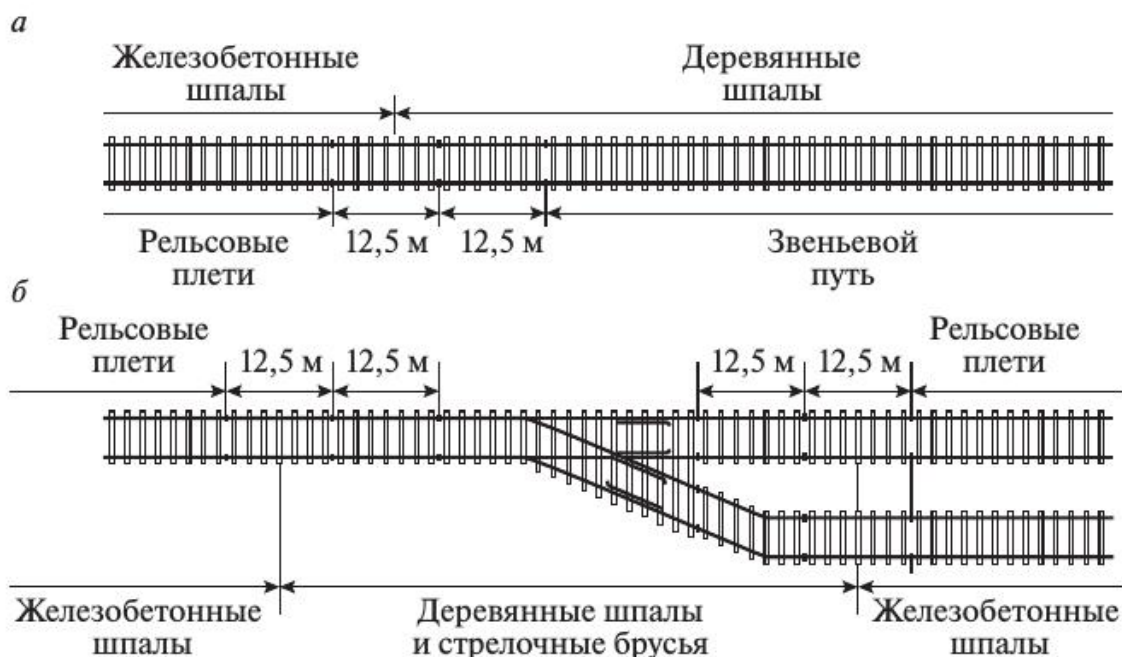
Схемы примыкания бесстыкового пути на железобетонных шпалах к звеньевому пути (а) и к стрелочному переводу (б)
